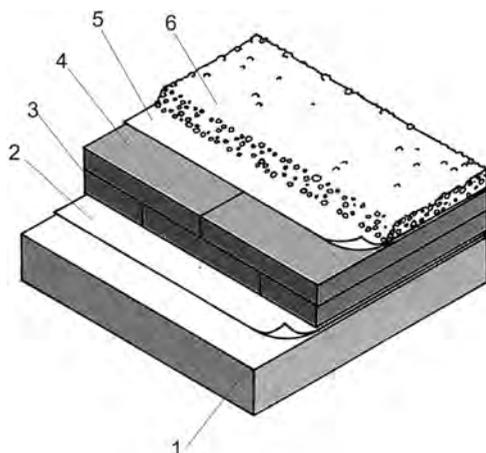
Утепление плоской крыши: 1 — железобетонная плита; 2 — подкровельная гидроизоляция; 3 — теплоизолирующие плиты; 4 — дополнительная теплоизоляция; 5 — подкровельная гидроизоляция; 6 — слой гравия
